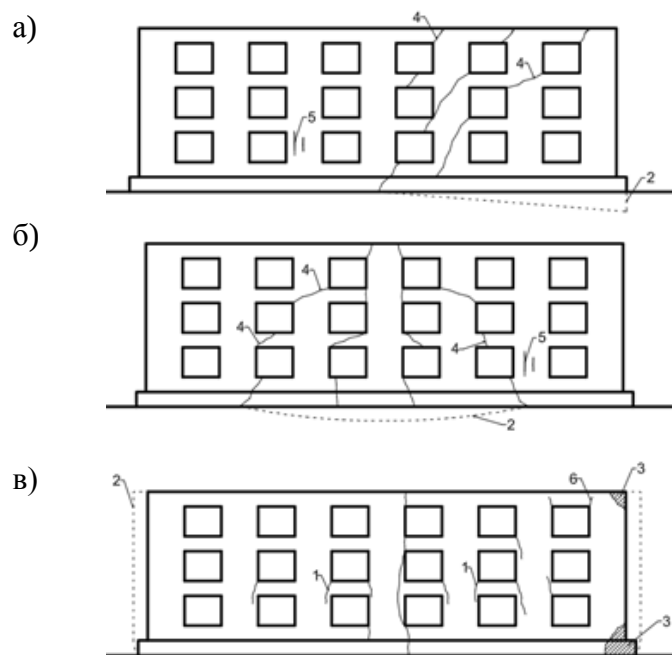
Схемы образования трещин в наружных стенах зданий [2]: а – от неравномерных осадок, б – силовые; в) температурные; 1 – трещины в кладке от температурных воздействий; 2 – линии деформаций здания и грунтов основания; 3 – разрушения от увлажнения; 4 – трещины от осадок фундаментов; 5 – силовые трещины от перегрузки простенков; 6 – трещины, вызванные разницей температурных деформаций железобетонных перемычек и окружающей каменной кладки
